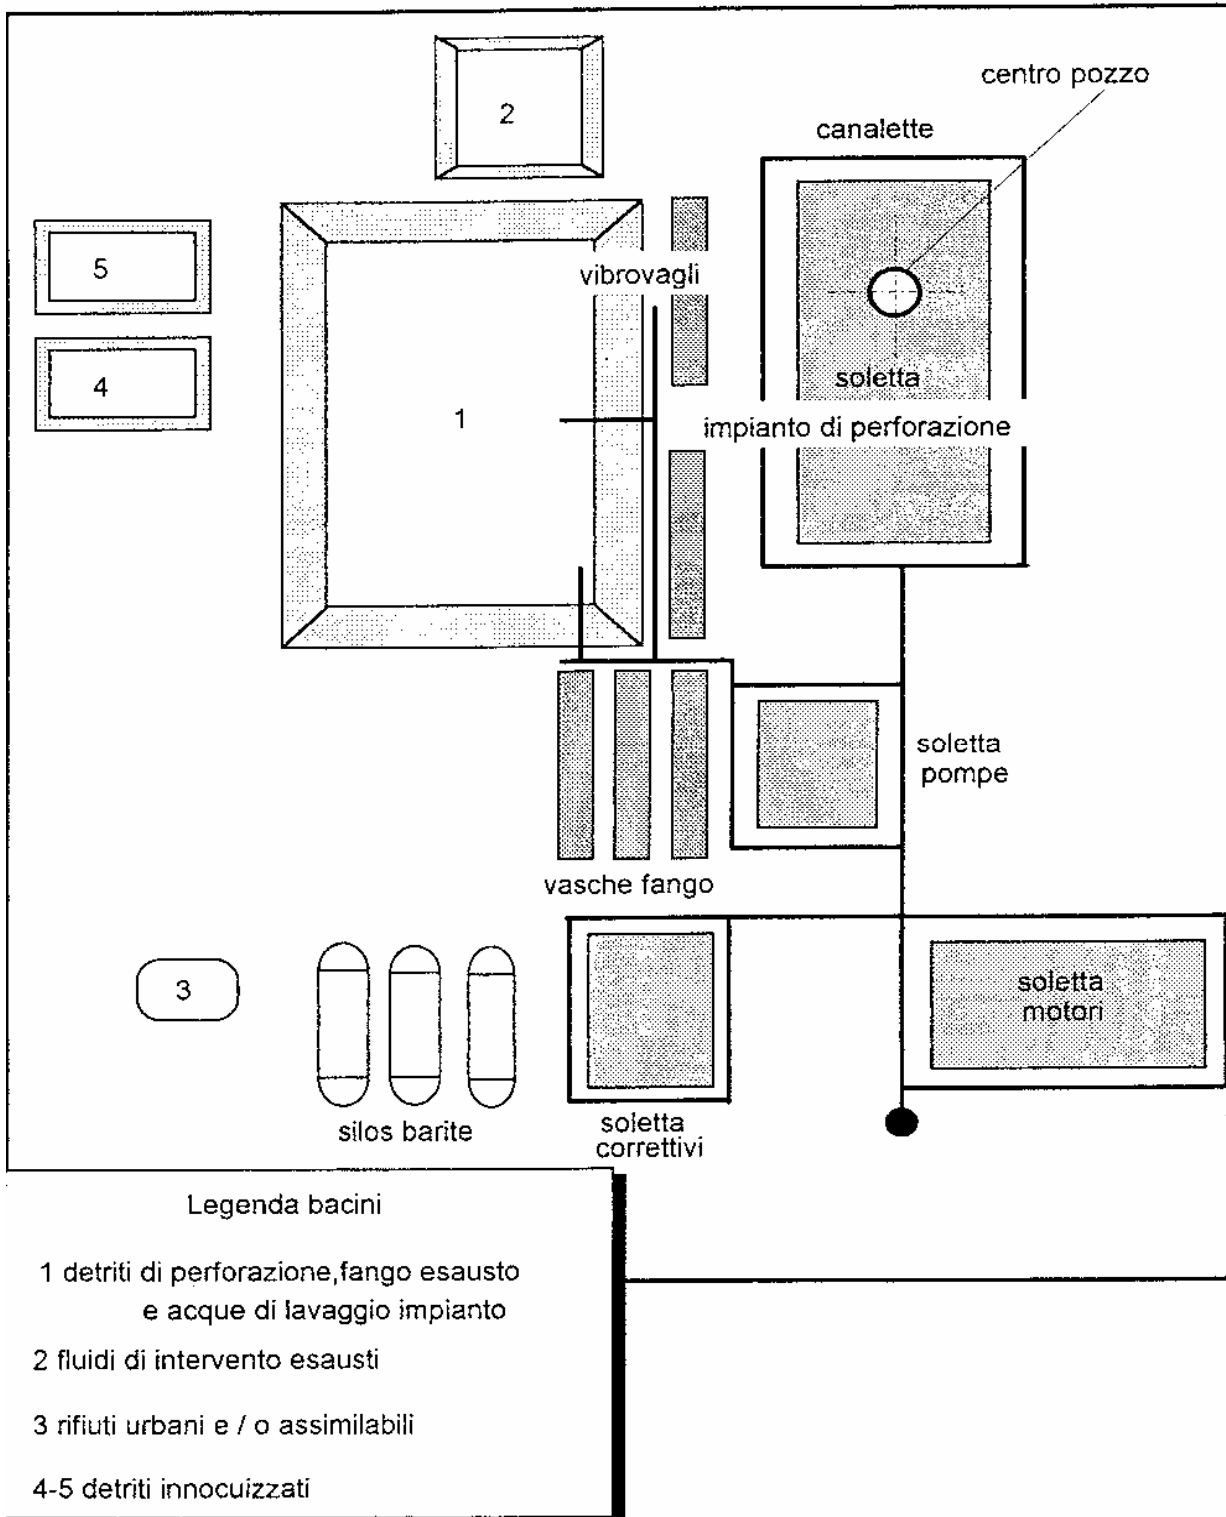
Schema della distribuzione impianti ed attrezzature
